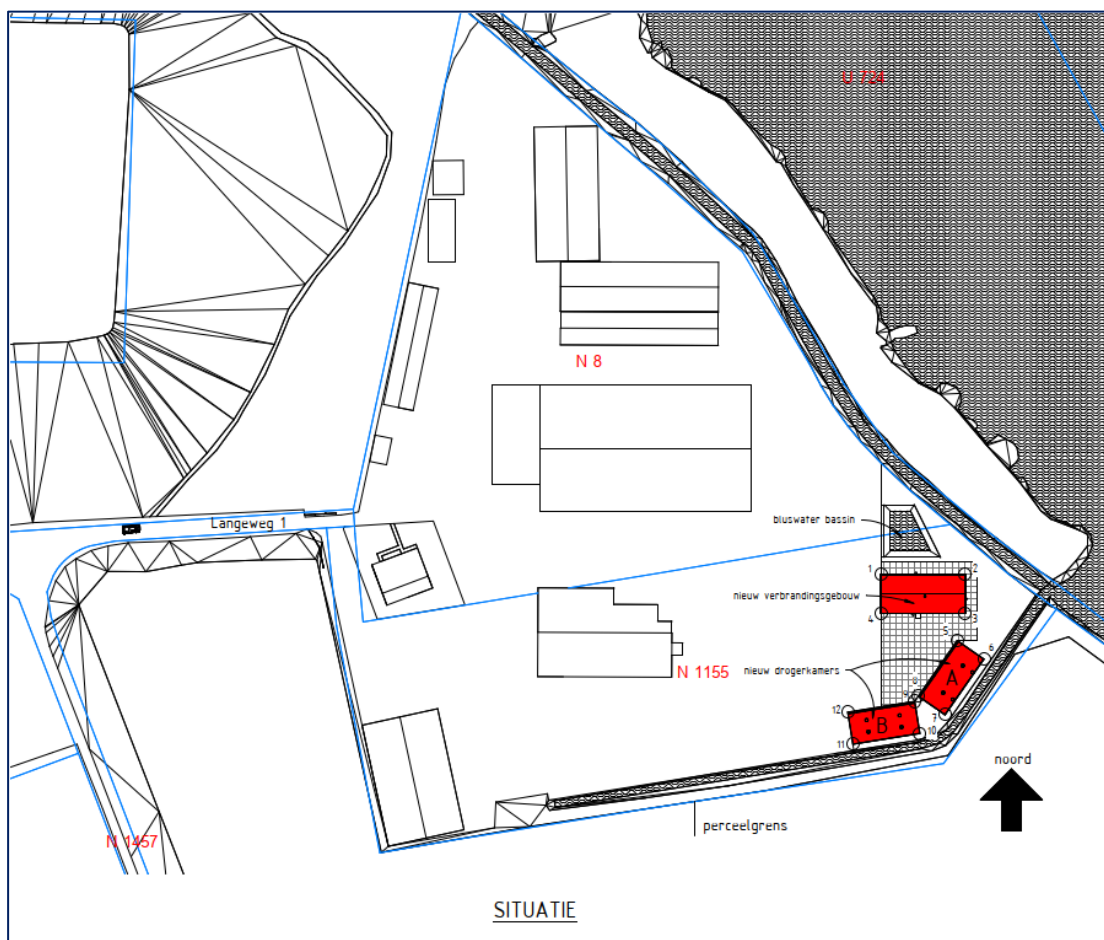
Uitbreidingslocatie voor biomassaketel en droogkamers
